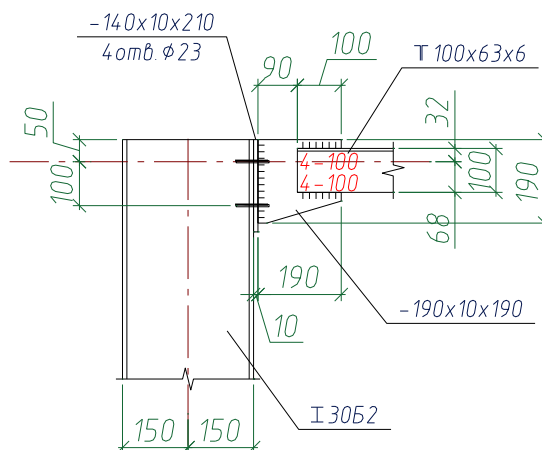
Узел примыкания верхнего пояса с надколонником
